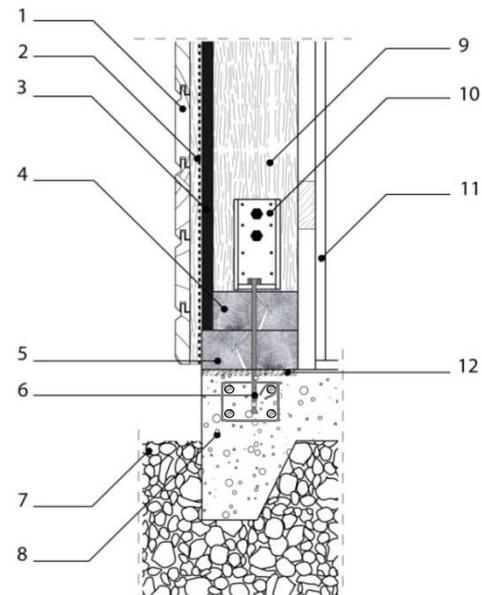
Coupe de principe : Détail ancrage lisse basse murs extérieurs sur radier panneaux de contreventement murs VT
